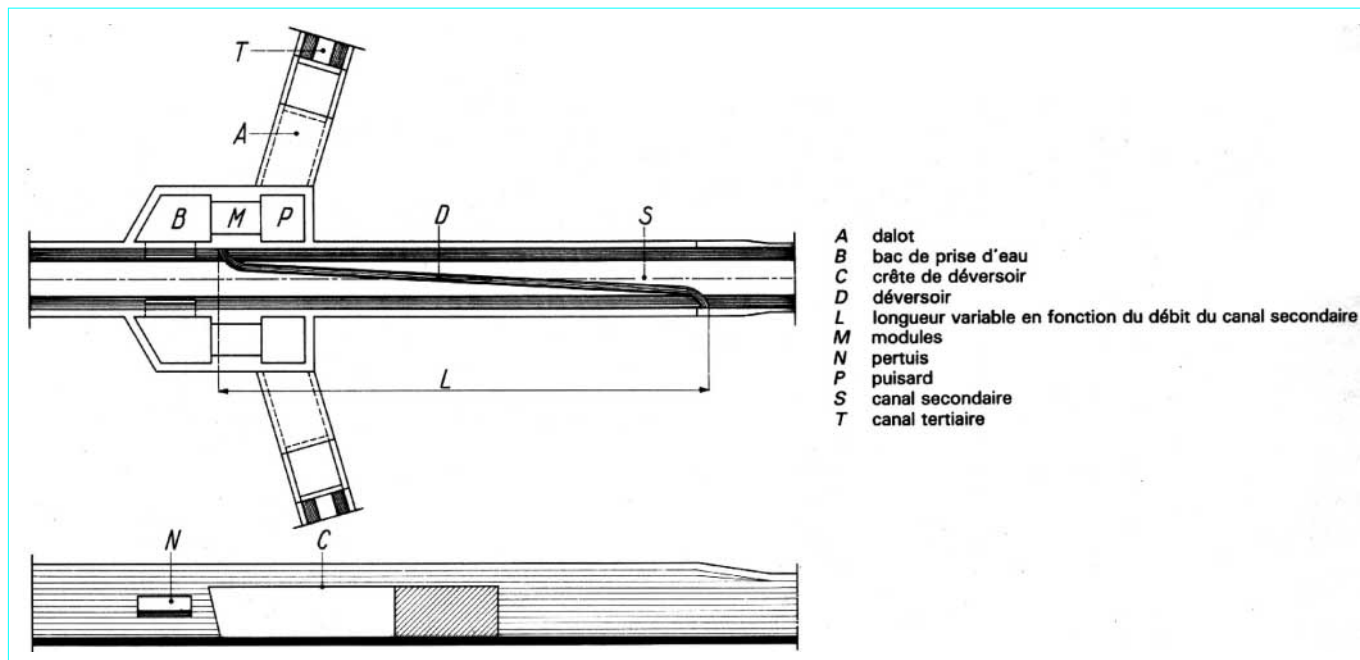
Ouvrage de prise de canaux tertiaires sur canal secondaire (vue en plan et coupe selon profil en long)
